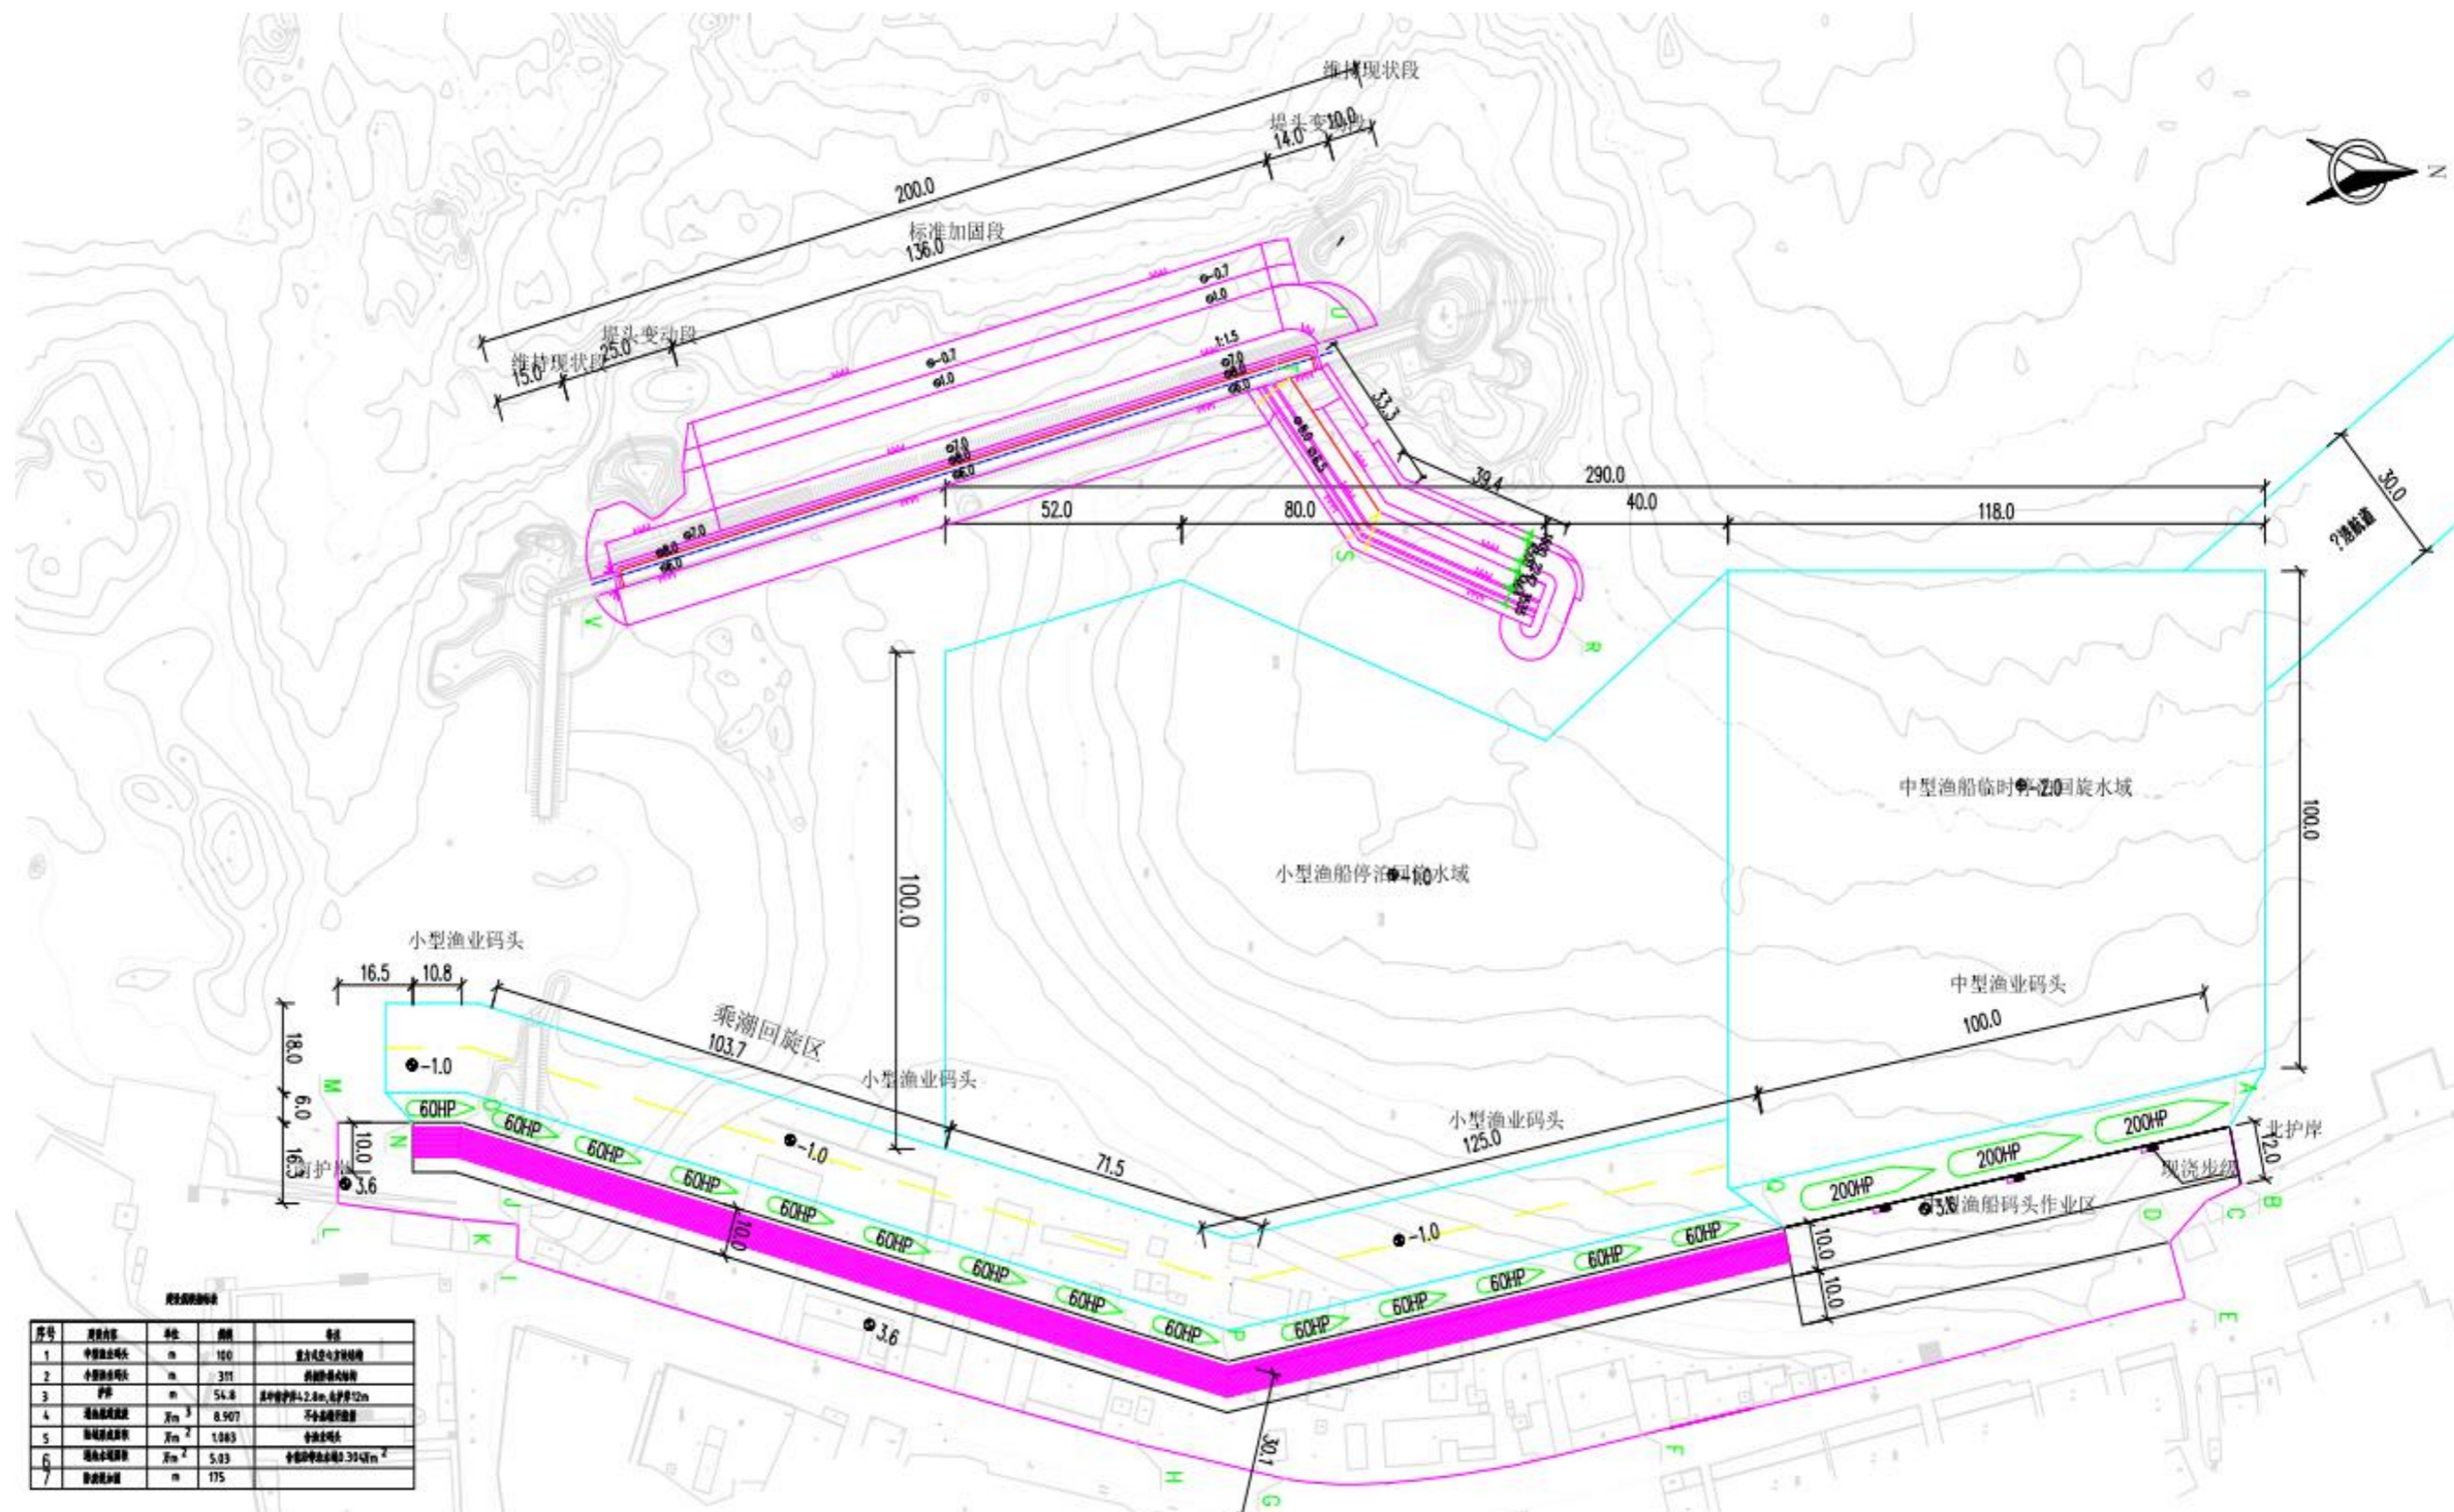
一期设计变更审查意见和实际建设遮浪渔港实施方案批复工程总平面布置图
